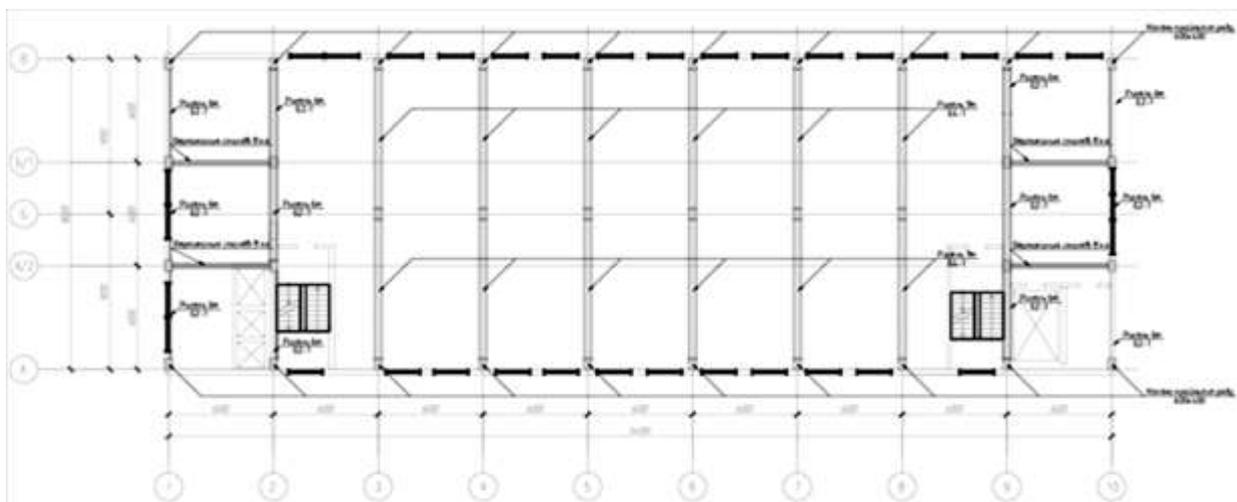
Схема розташування несучих конструкцій на плані типового поверху промислової будівлі до її реконструкції
